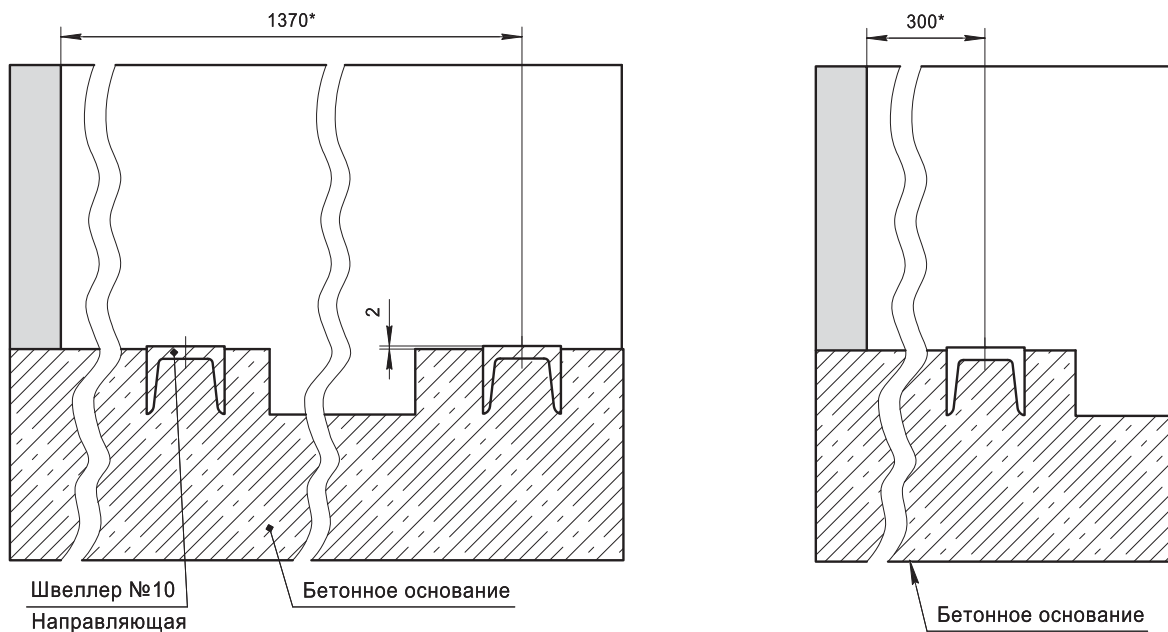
Подготовка пола для установки шкафов КМП-С.
